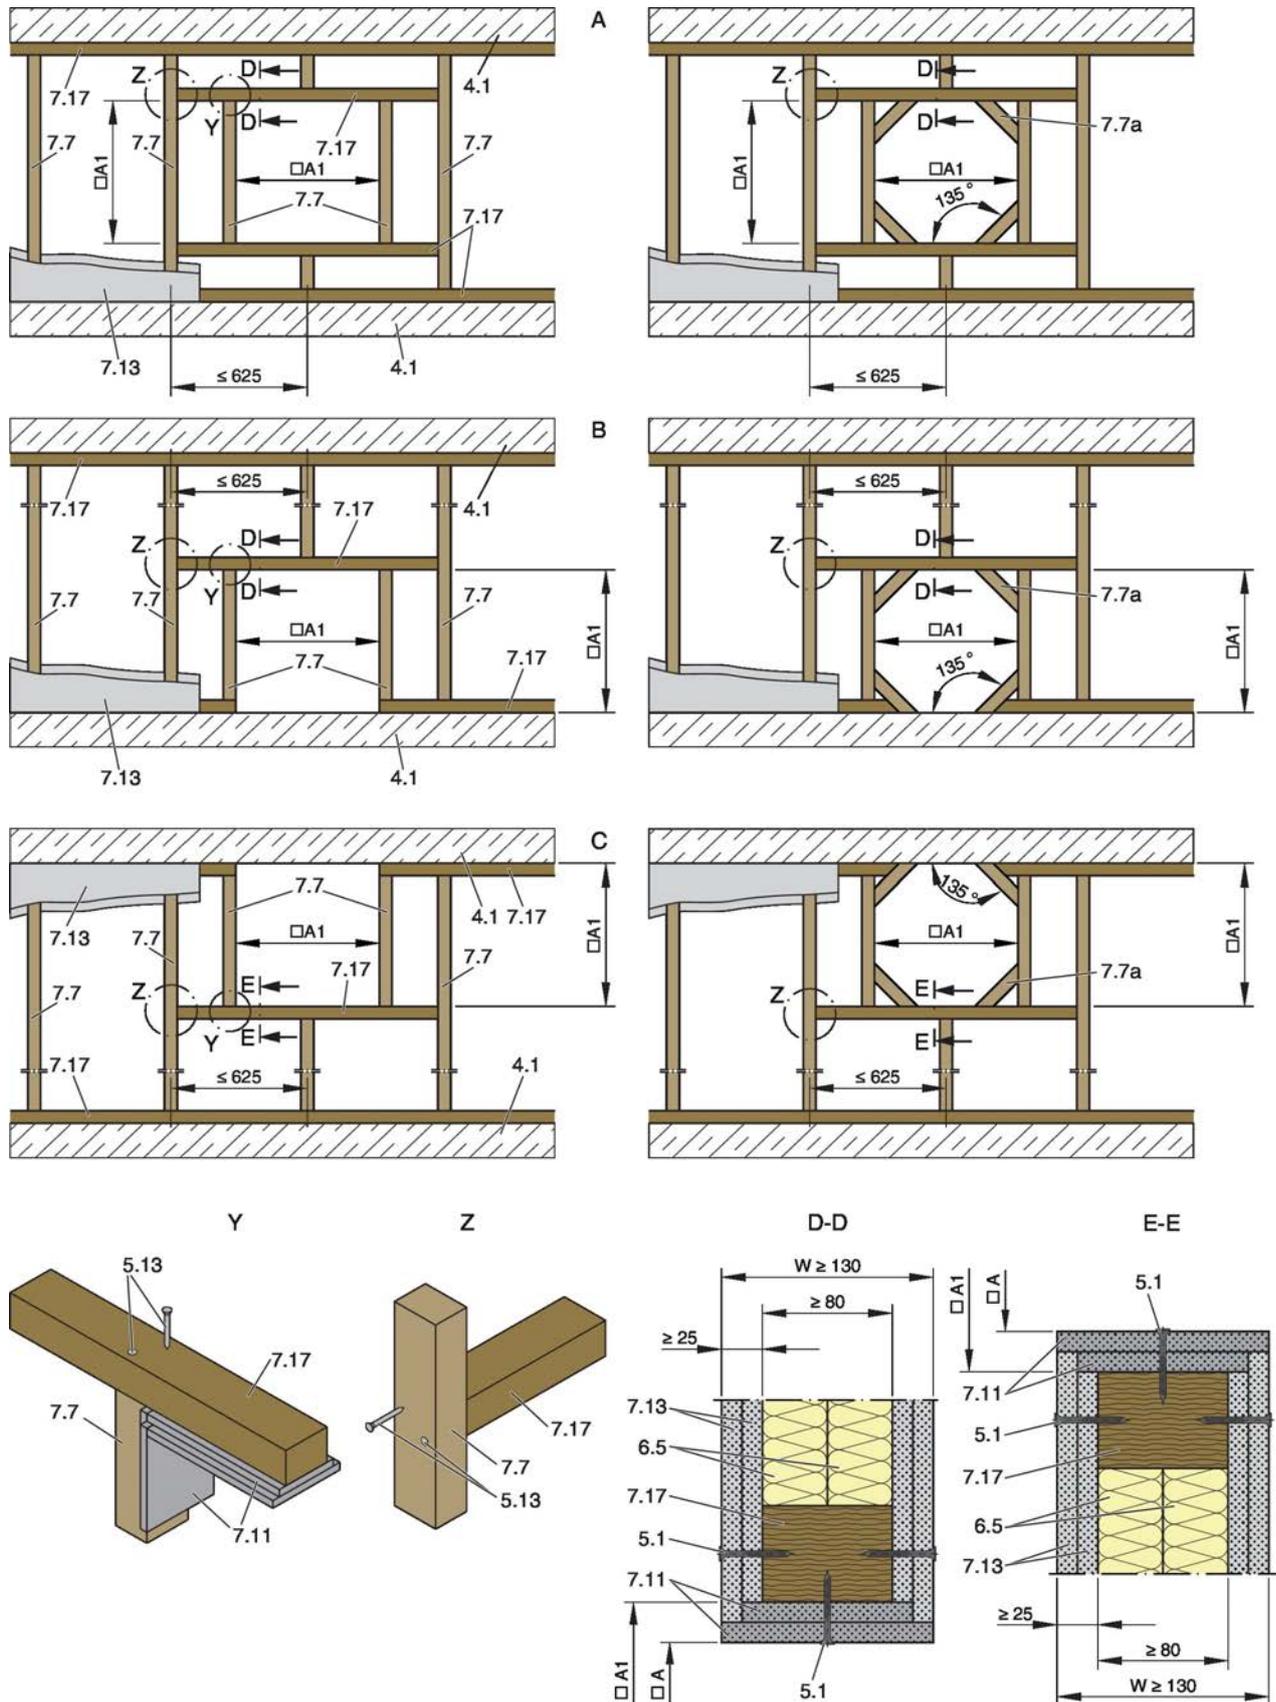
Parede divisória leve com estrutura de apoio de madeira e revestimento em ambos os lados
